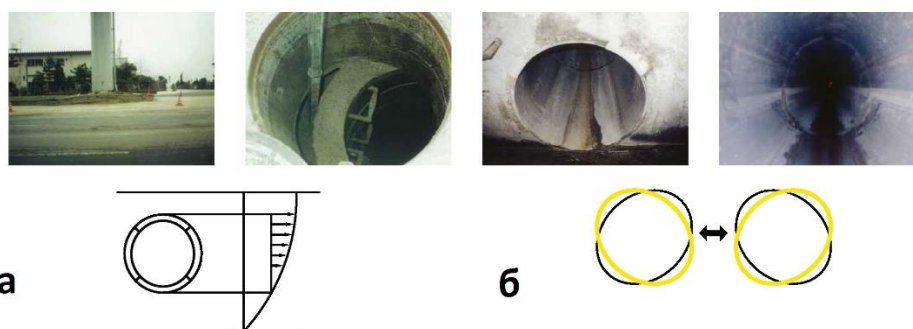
а) железобетонная труба после землетрясения (бетон трескается); б) стеклопластиковая труба после землетрясения (изменяет форму, не трескается)
